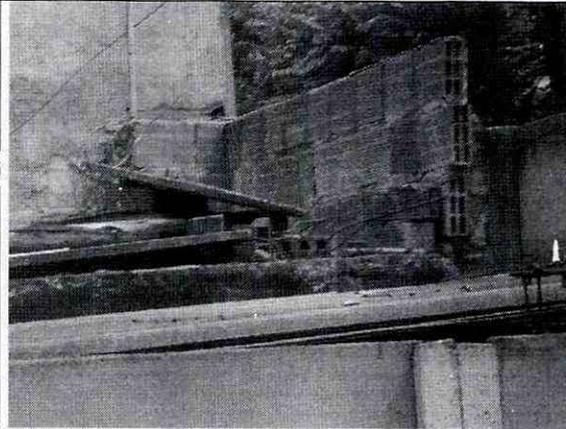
Placa de cubierta de la zona frontal y antepecho de fachada en buen estado.
